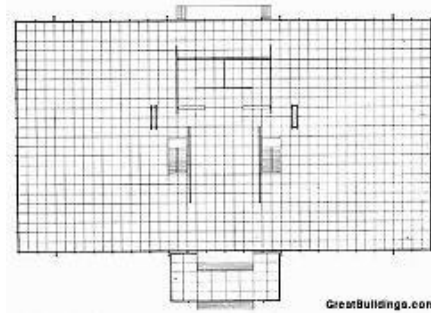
Pembentukan ruang S. R. Crown Hall
